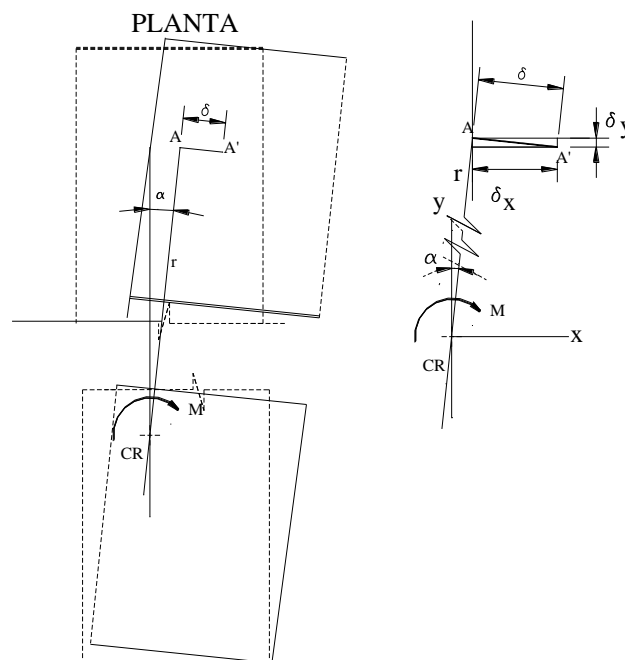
28 - Planta de pavimento contraventado por pórticos, que podem ser substituídos por molas, solicitado por um momento atuando no centro de rigidez (C.R.).
